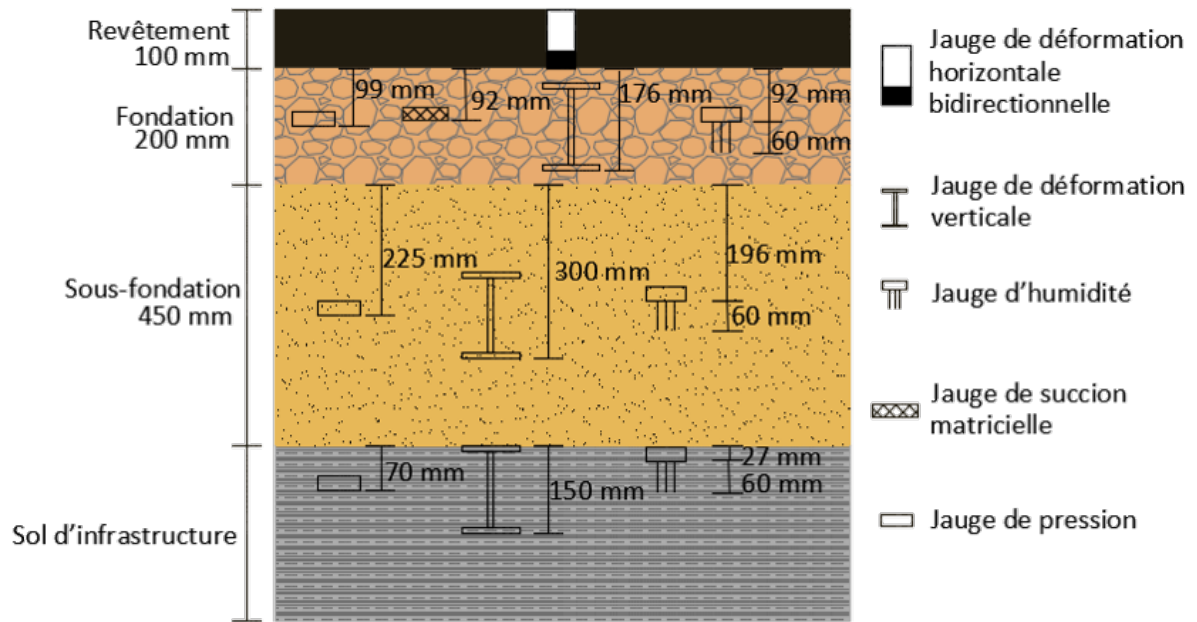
Instrumentation de la section 100 mm au SERUL
